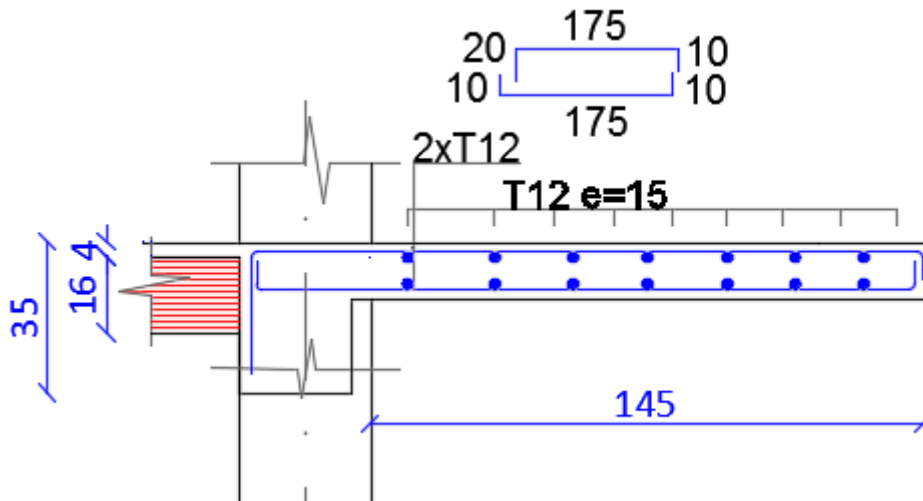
Schéma de ferrailage de balcon «coupe transversale»
